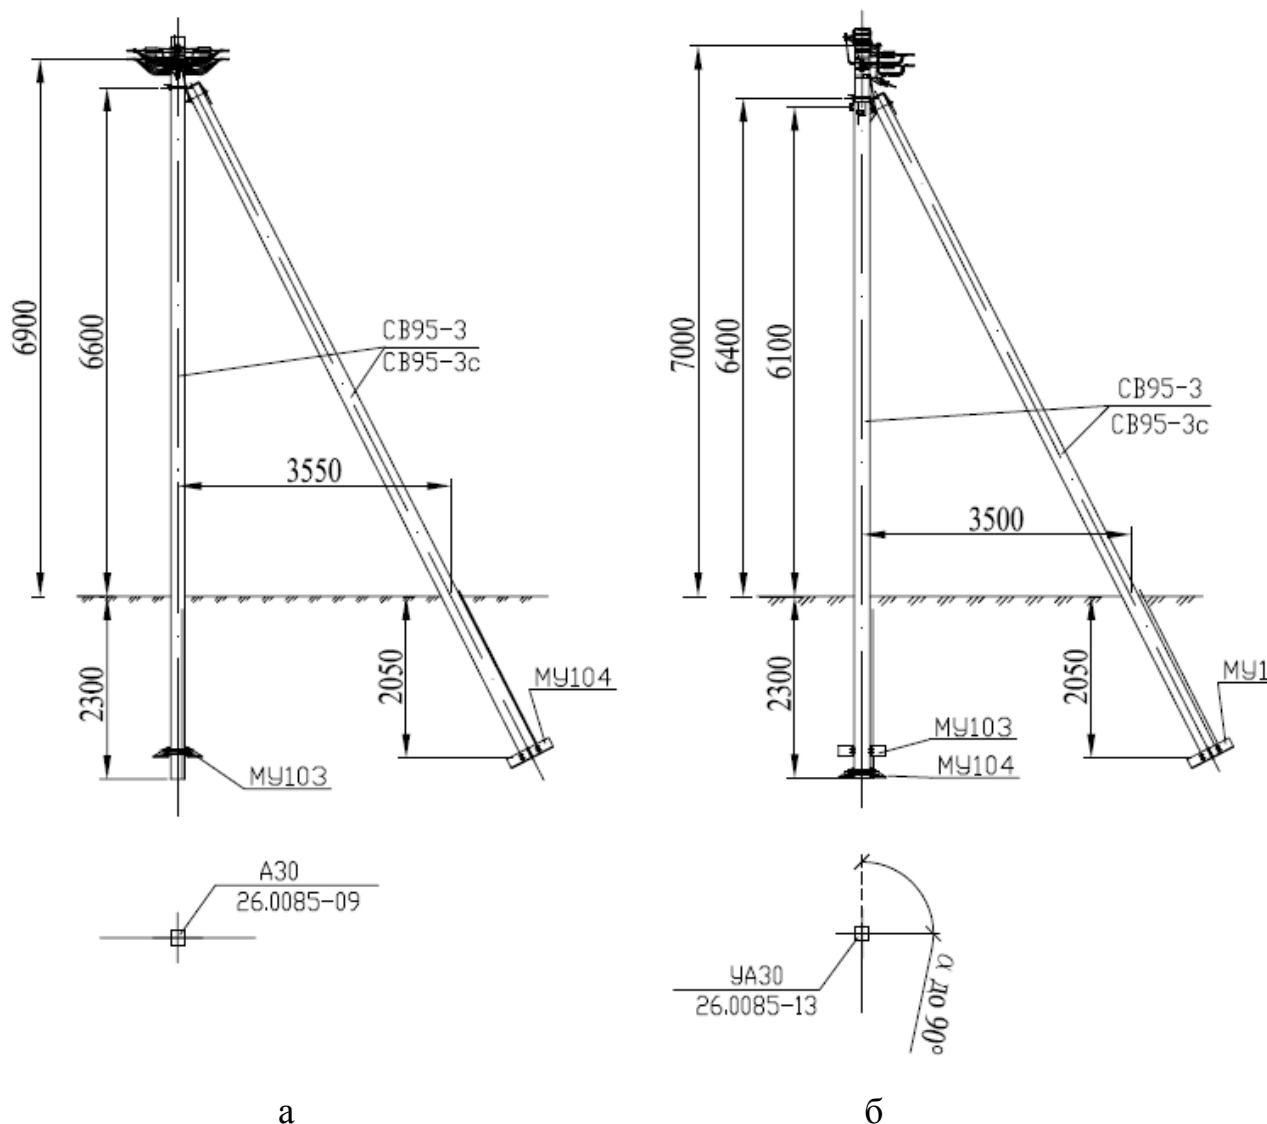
Конструкции двухцепных железобетонных опор для ВЛИ
